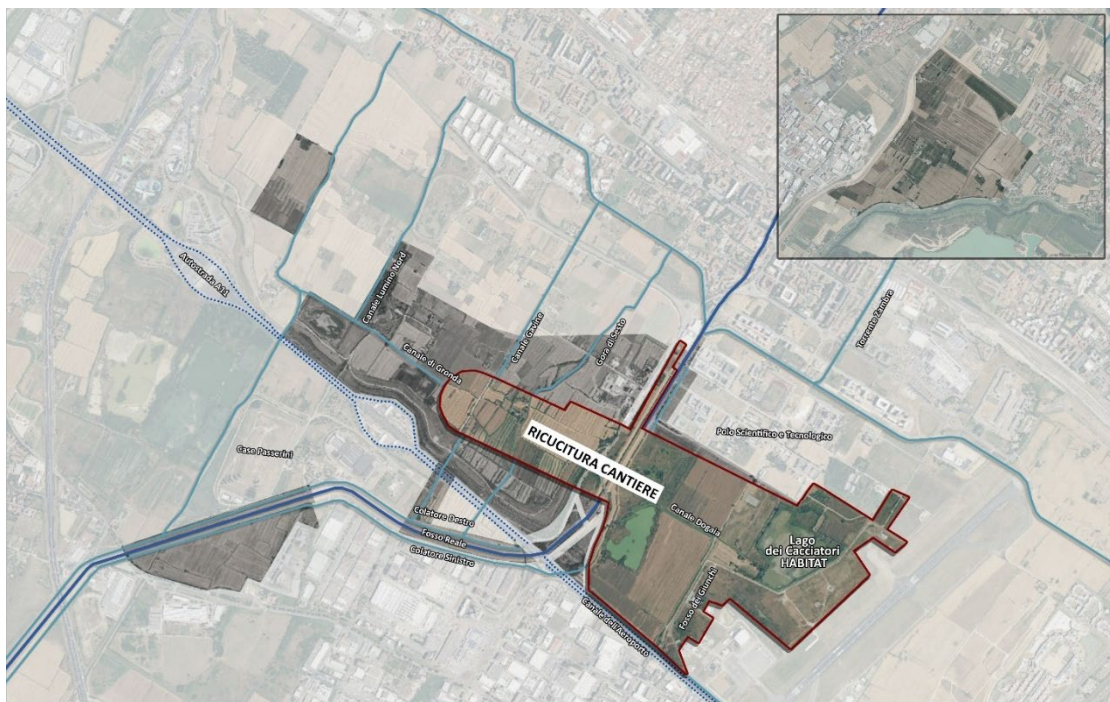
Planimetria di cantierizzazione: ricucitura macrolotti
